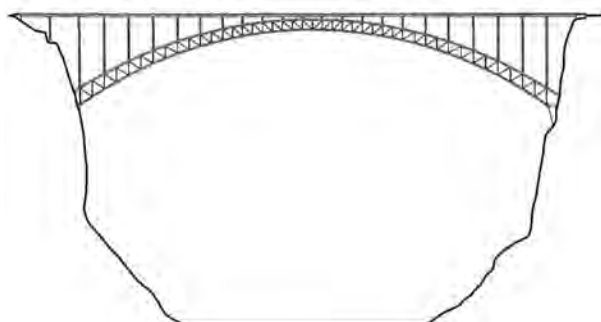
Schema arcului pleoștit cu zăbrele de 387 m deschidere, de pe US 89, construit în aval de barajul din Glen Canyon
